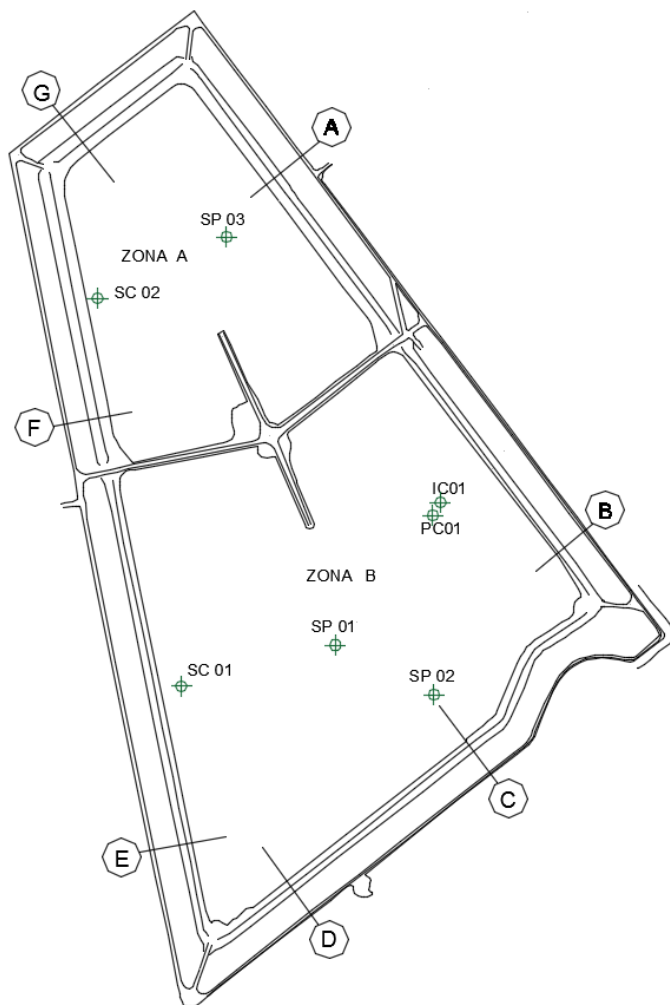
Planimetria del bacino e ubicazione dei sondaggi.
